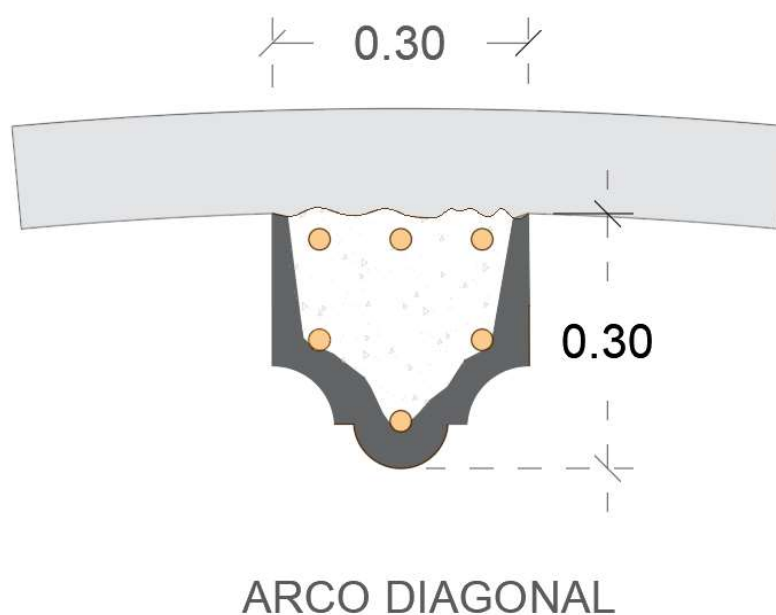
Detalle en sección del arco diagonal, hormigonado juntamente con las bóvedas.
